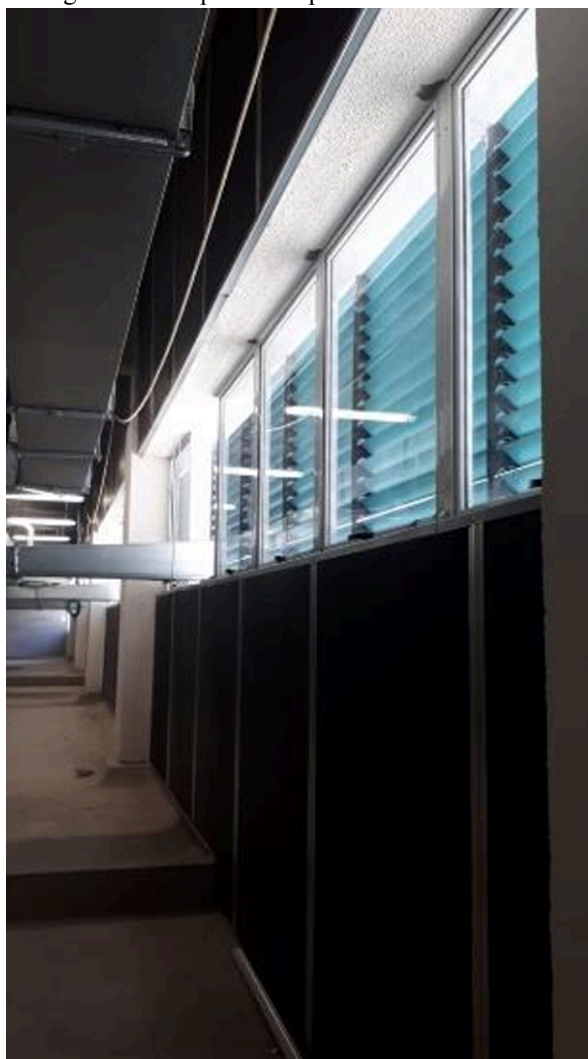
Impermeabilização de piso no Pavimento Mecânico.
